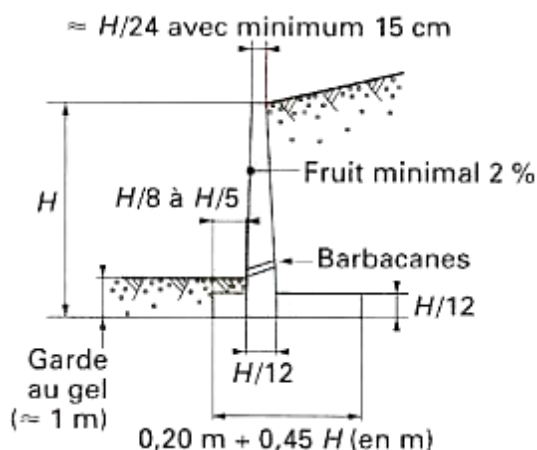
Pré dimensionnement d'un mur de soutènement
